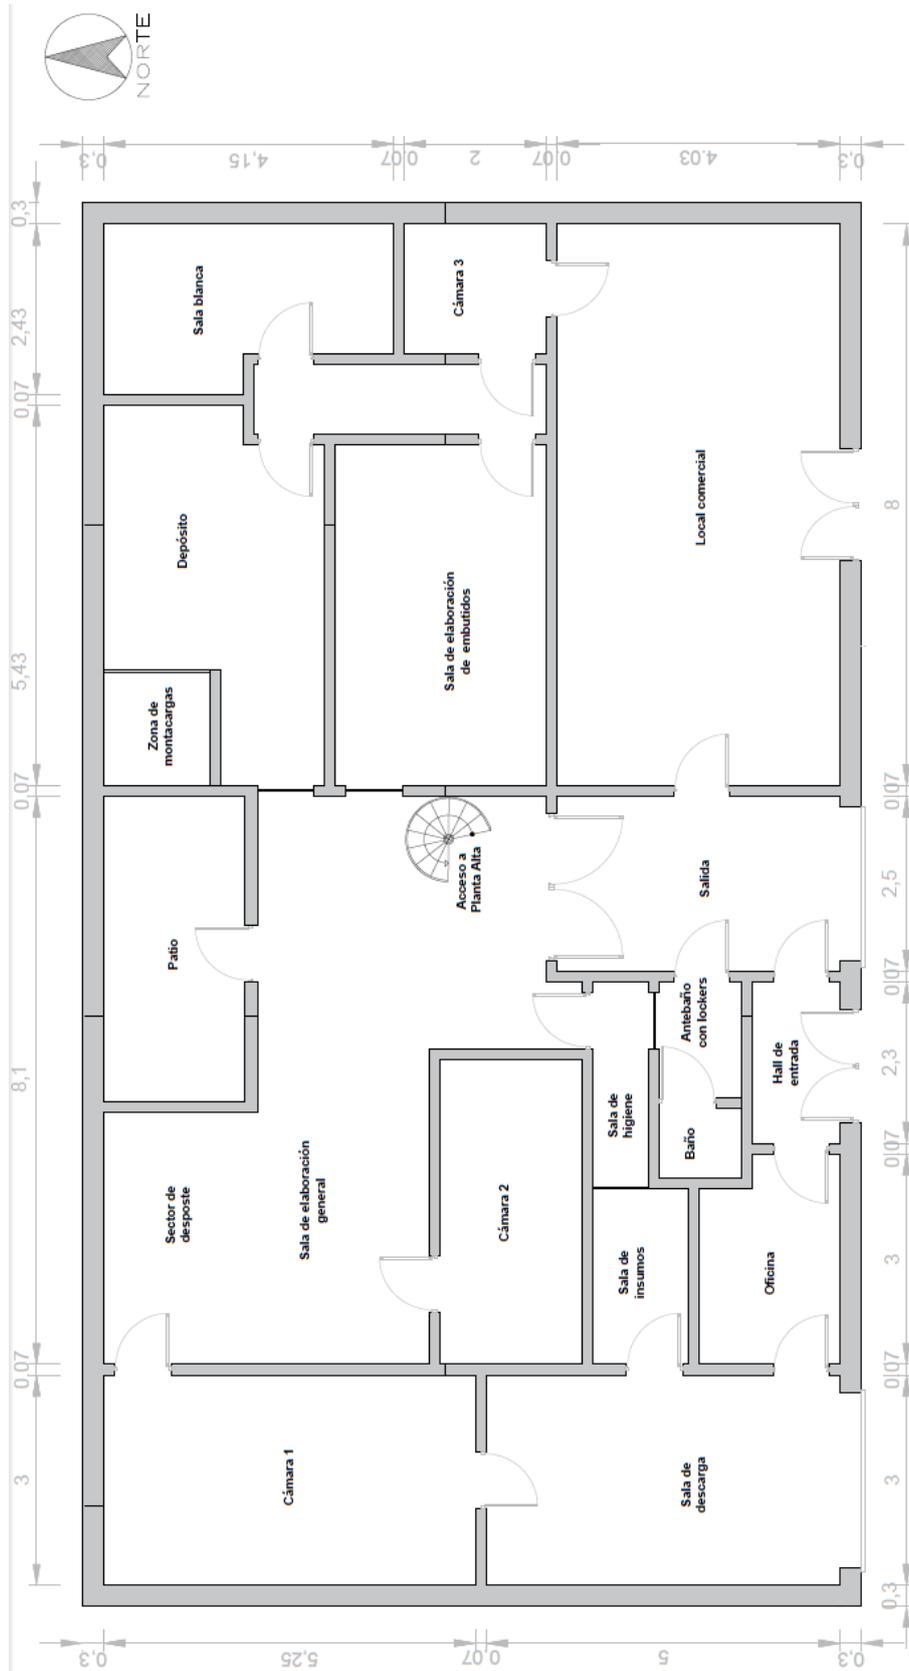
LayOut - Sector salas planta baja (Segunda etapa)
